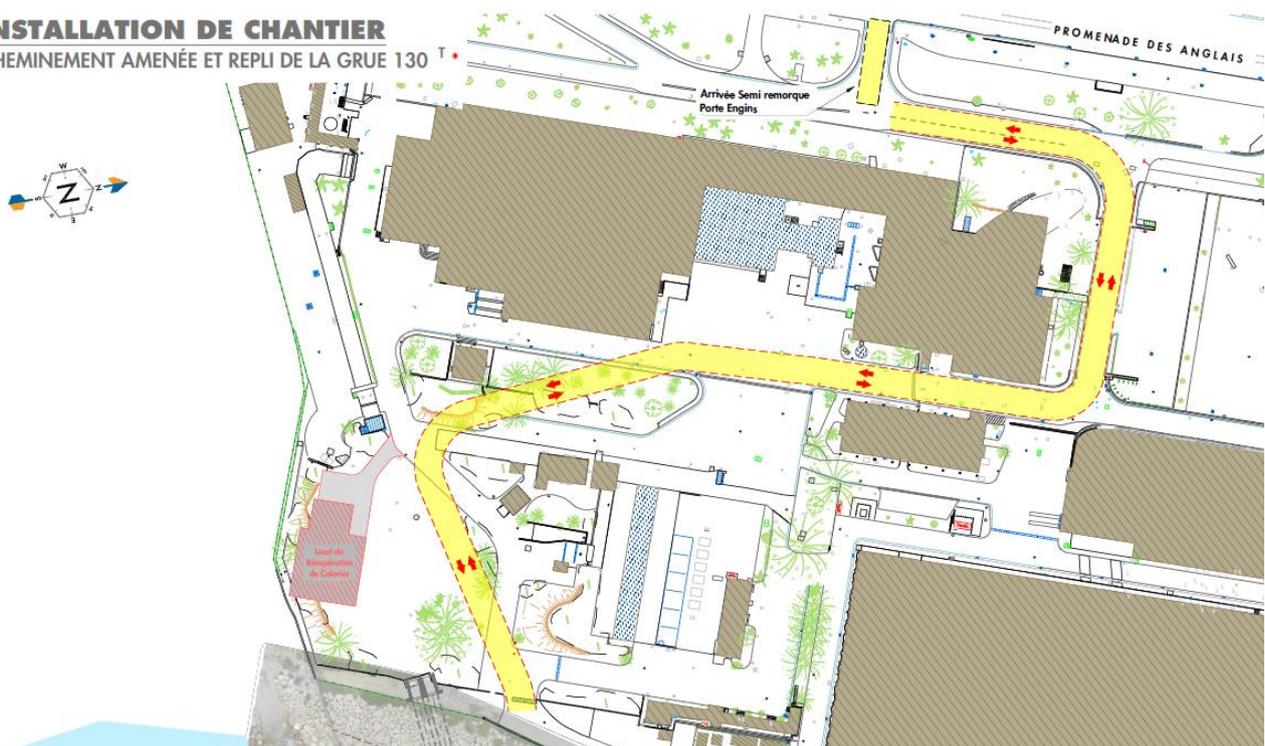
Plan de cheminement de la grue pour accéder à la zone de travaux
